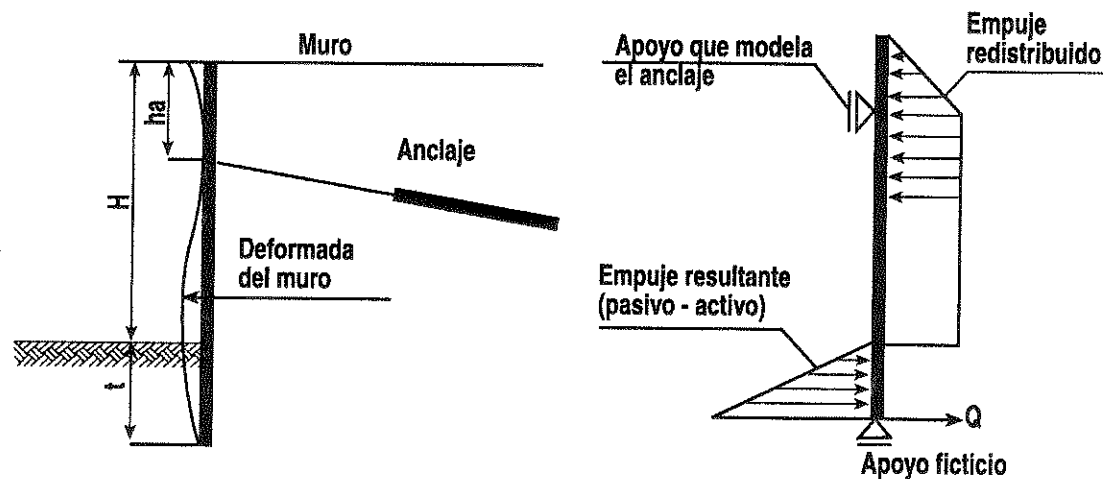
Modelación de muros para el cálculo de cargas en los anclajes
